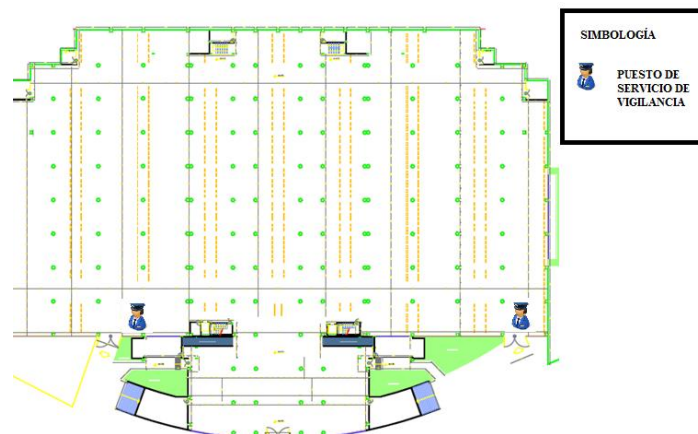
Ubicación de puesto de vigilancia y seguridad privada en el estacionamiento planta baja
